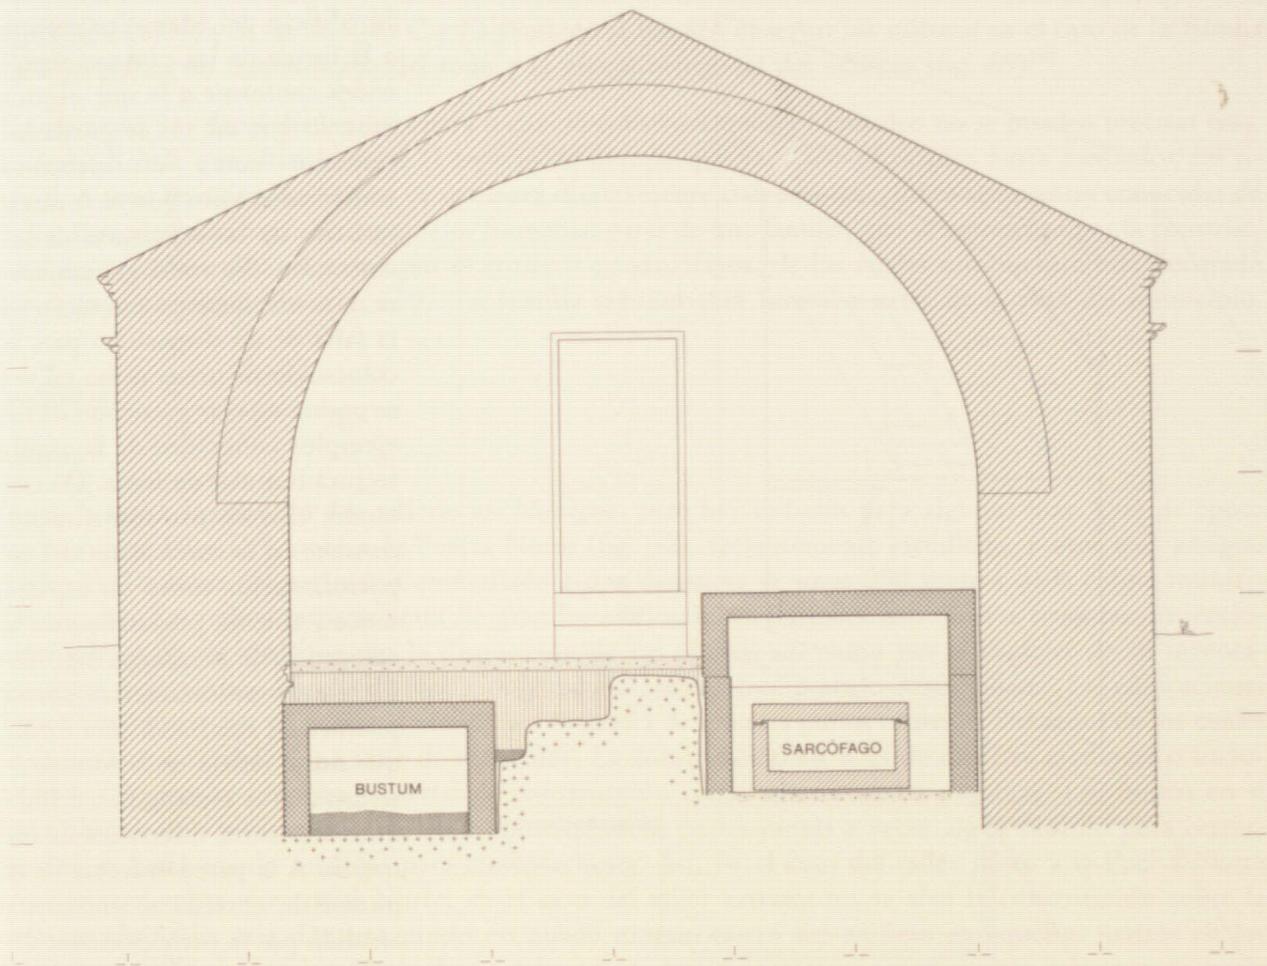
Mausoleo. Reconstrucción corte transversal, vista hacia el sur.
